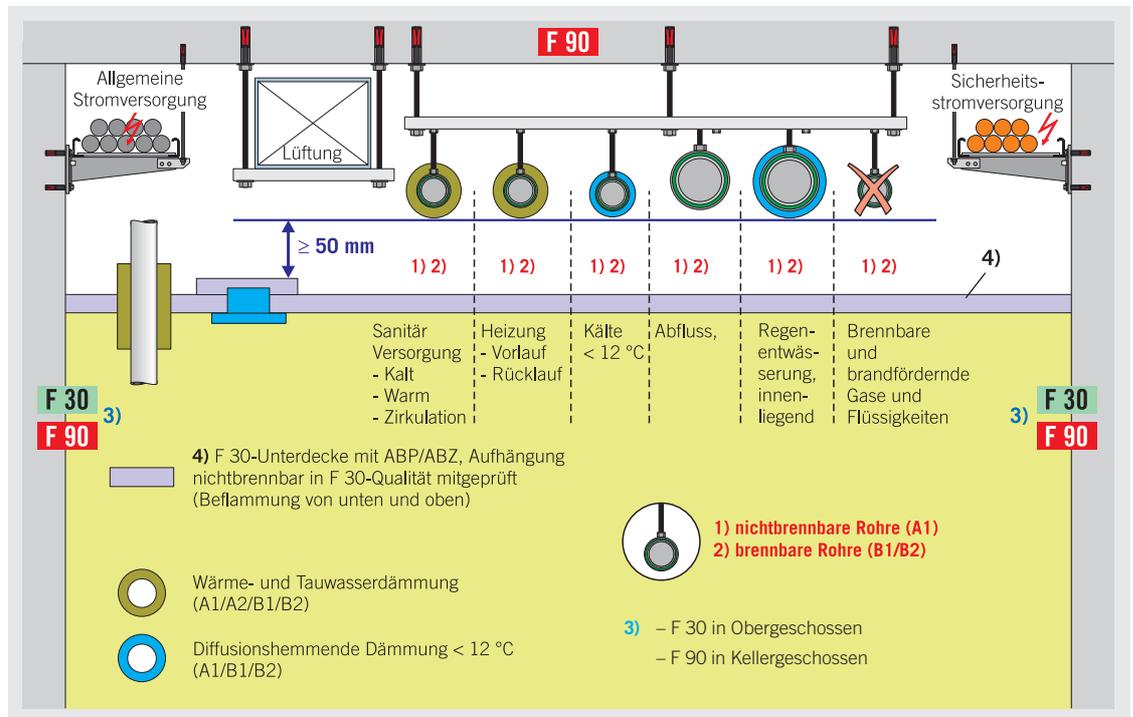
Leitungstrassen oberhalb einer F 30 Unterdecke (Nachweis der Brandbeanspruchung von oben und unten erforderlich).
